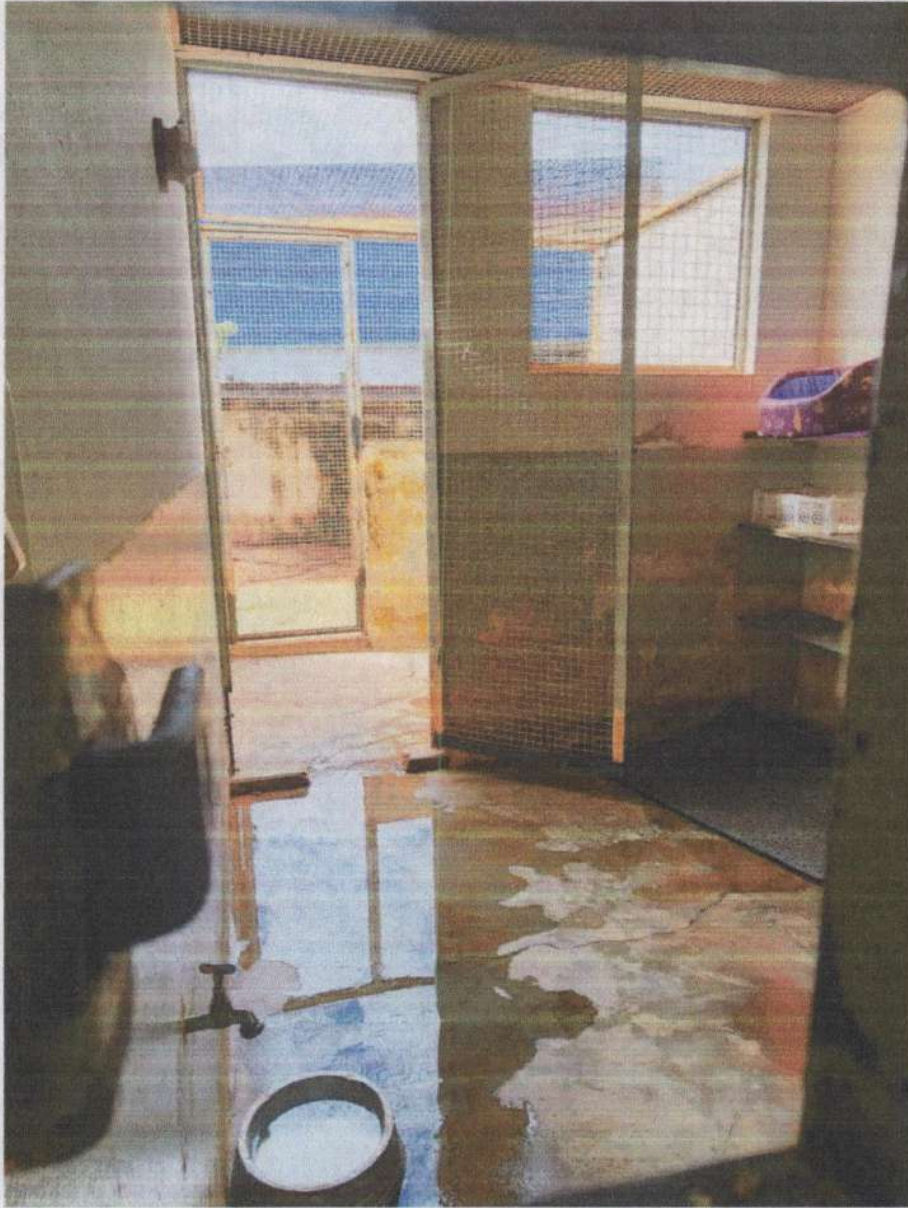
Patologias diversas de infiltração, acúmulo de água no piso, instalações antigas e estrutura metálica com oxidações e corrosões.
